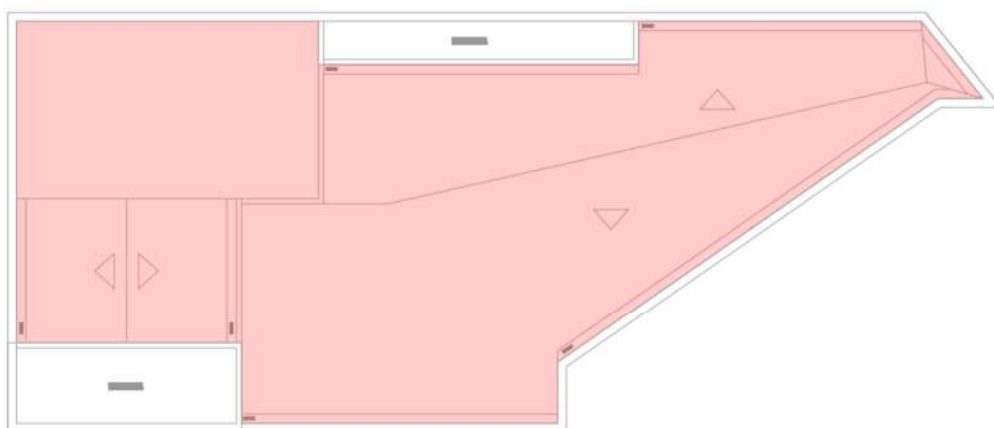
Telhado / estrutura em madeira telhado / rufo / calhas - A remover
